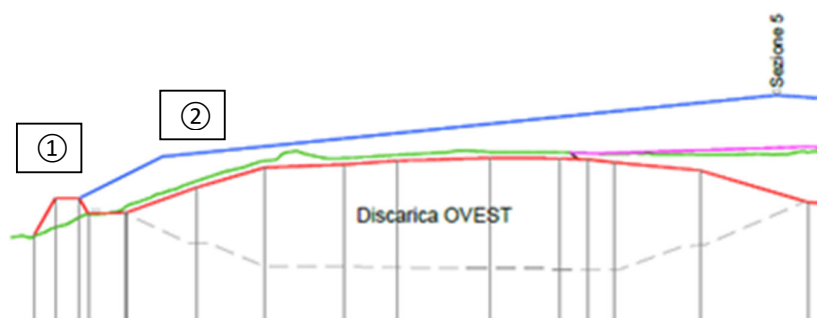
Tipologica sezione con canaletta in cima alla terra armata e scatolare prefabbricato
